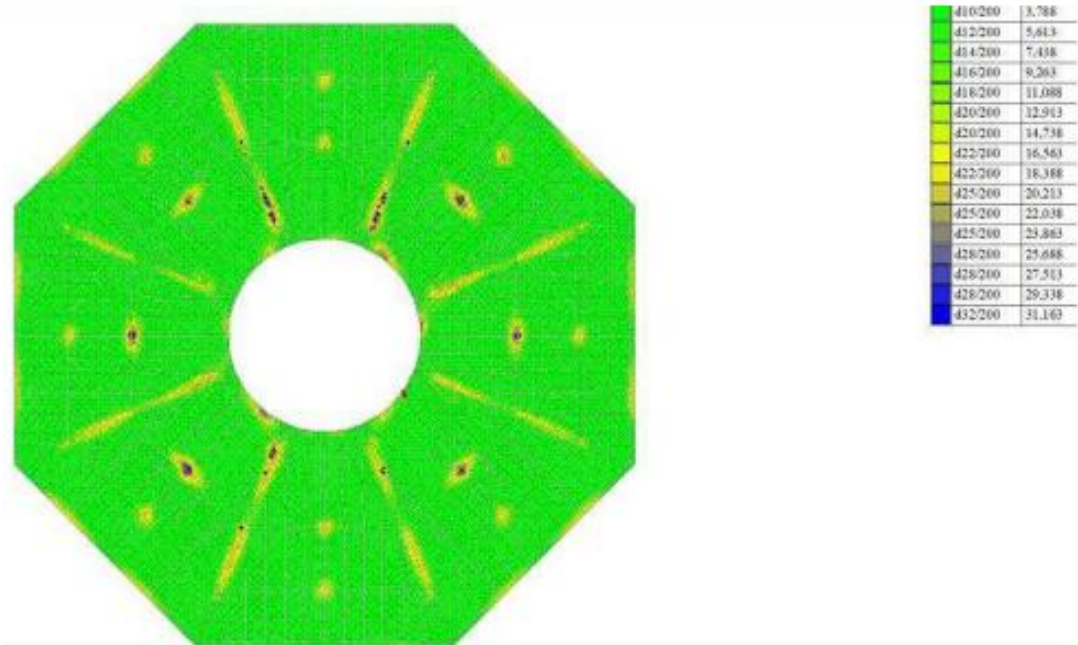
Армування плити перекриття на відм.-9,000 з інтенсивністю S_2
